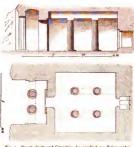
Durchschnitt und Grundriss des nordlichsten Felsengrabes von Benihassan.
